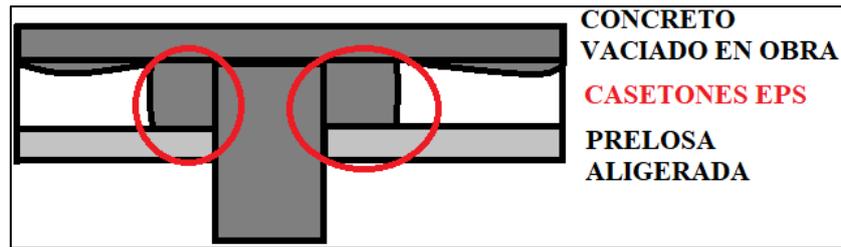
Detalle de encuentro de prelosa aligerada con casetones desalineados y viga.
